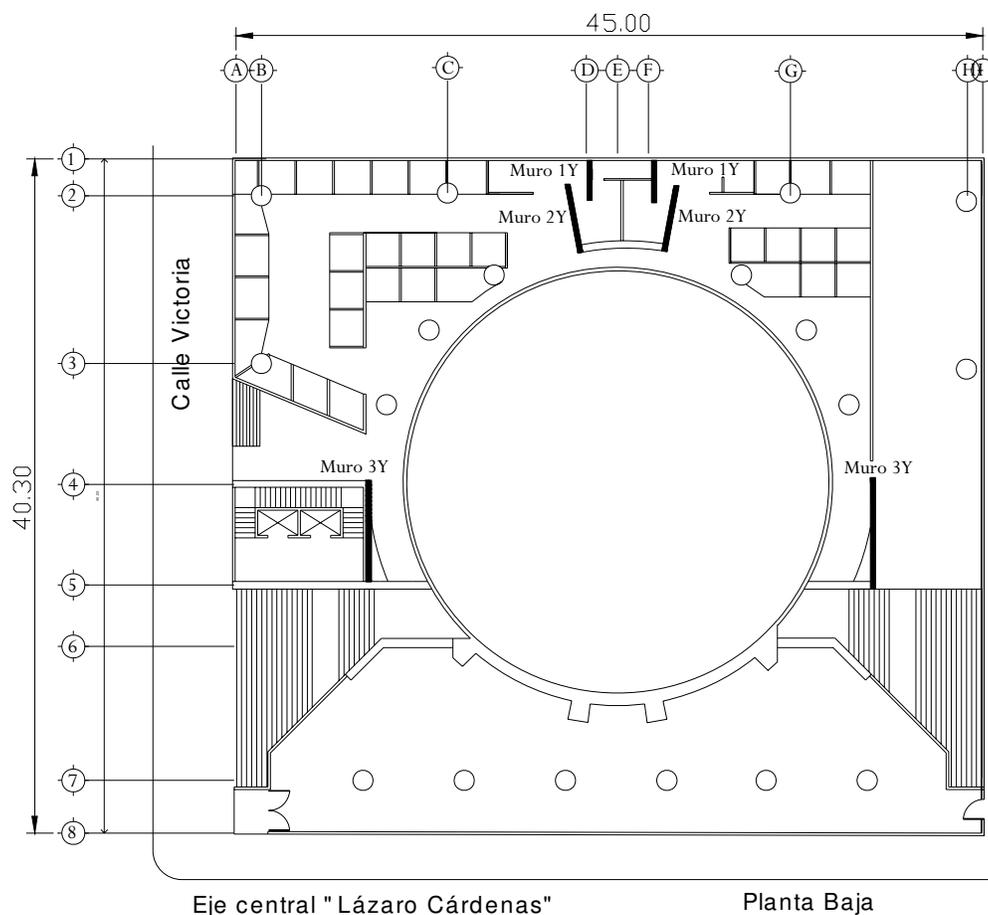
Distribución de muros de rigidez en dirección y en planta baja, edificio Victoria 7
